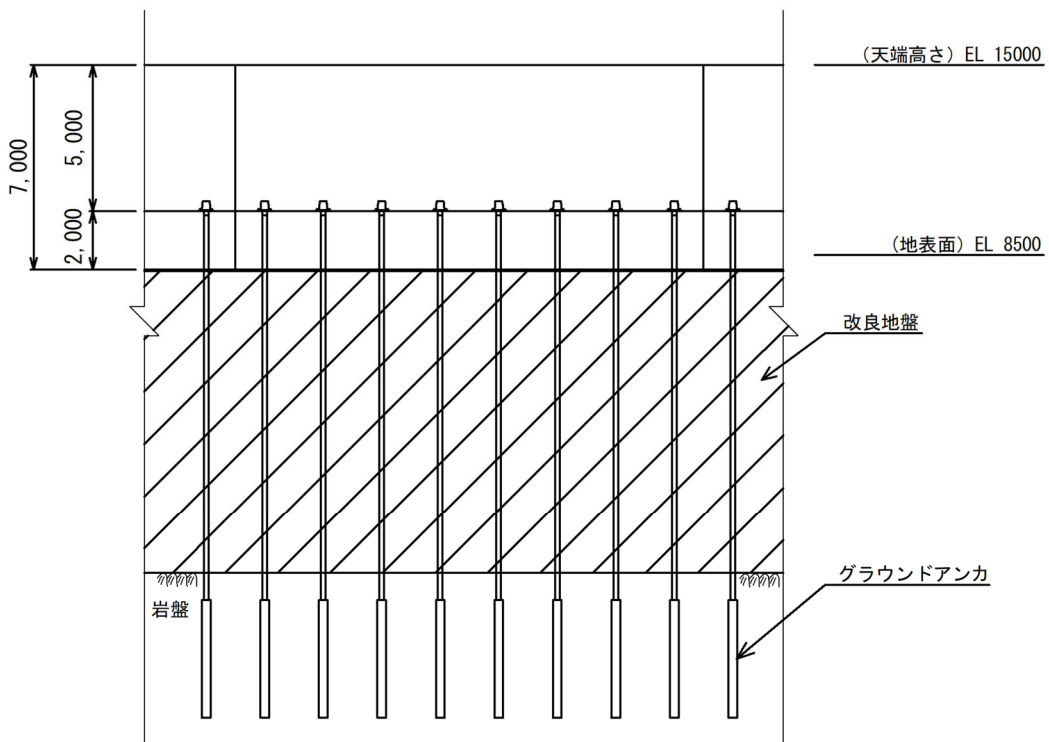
防波壁（逆 T 擁壁）の構造図（正面図）
